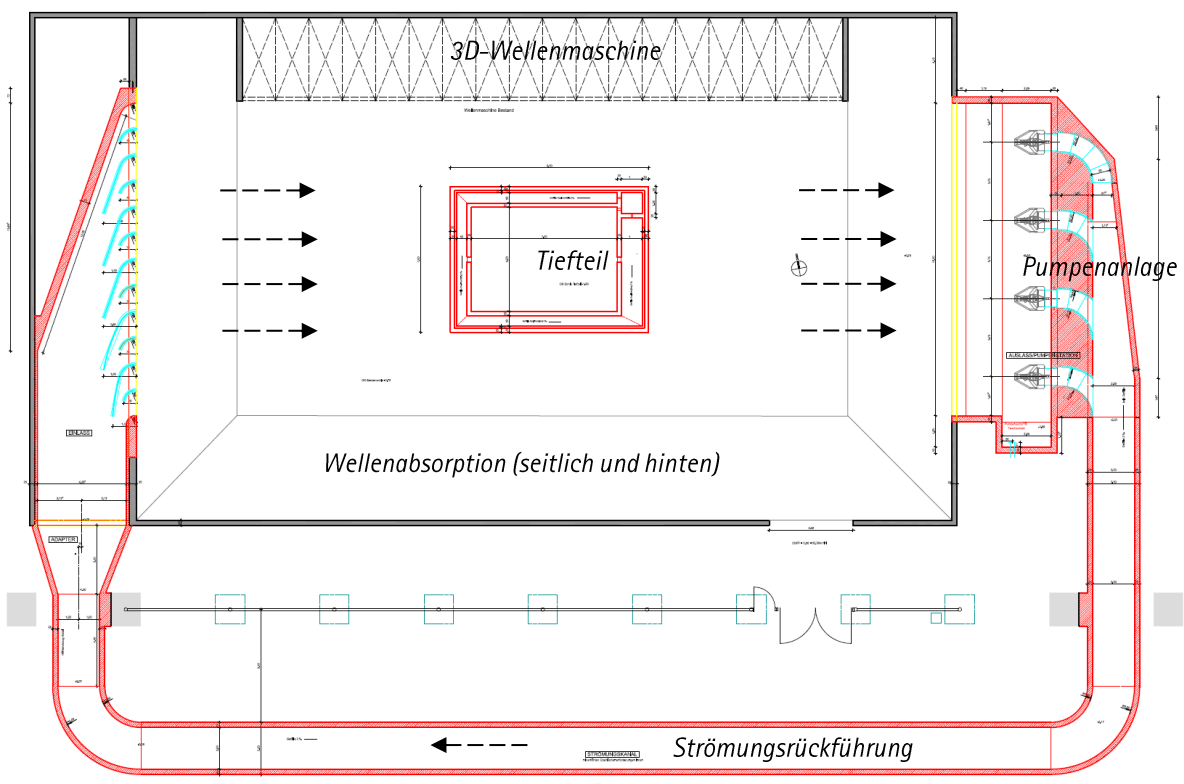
Übersicht im Grundriss zur finalen Beckenerweiterung mit Tiefteil, Ein- und Auslasselementen, Pumpenanlage und Rückführungskanal.
